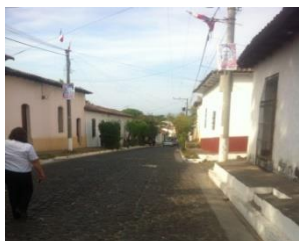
Tipo de pisos en Calles de Suchitoto
